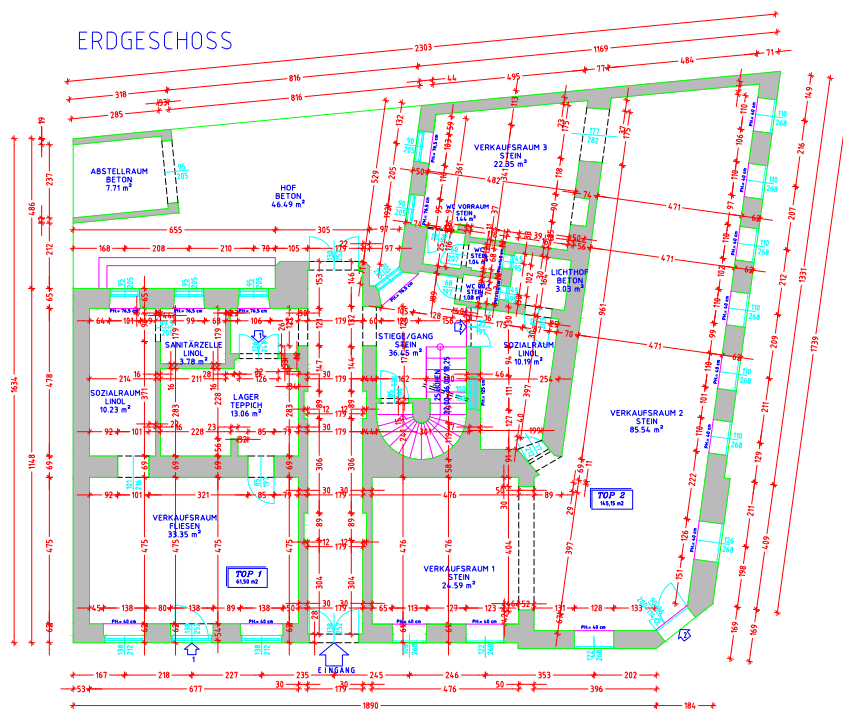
Beispiel eines Grundrissplans von einem Stockwerk, erstellt mit einer CAD-Applikation.
